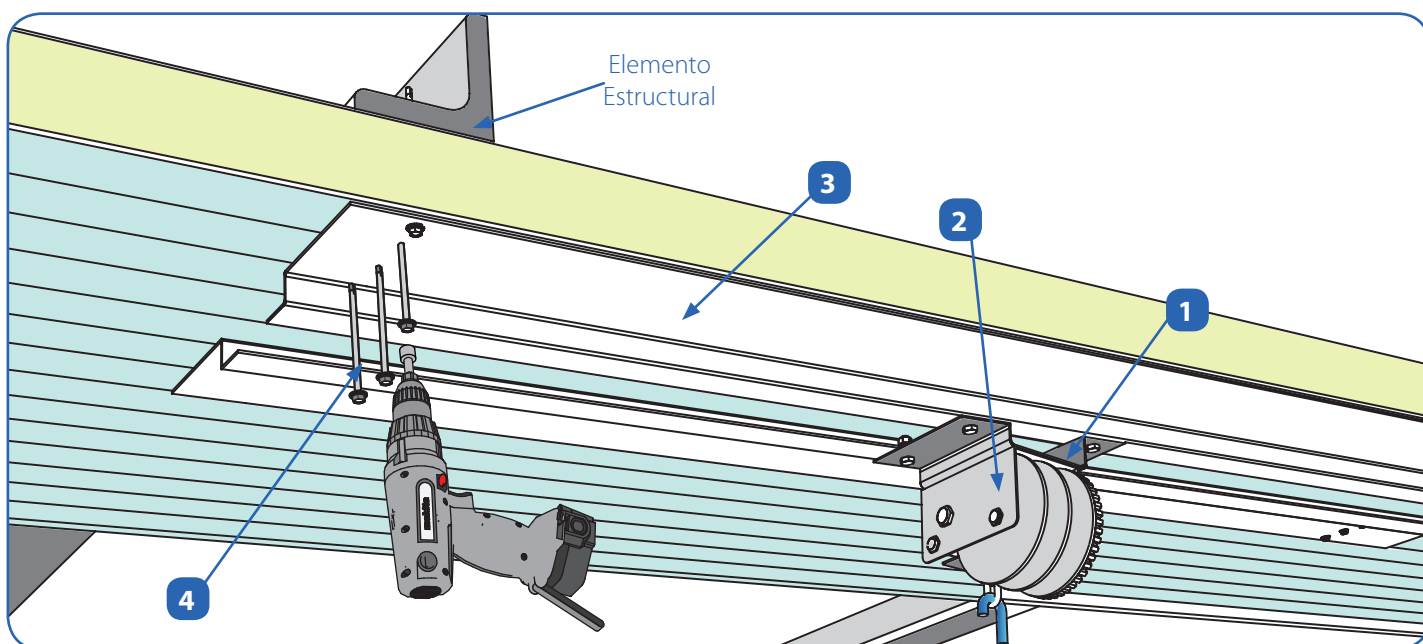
Zona de anclaje del Soporte torno en cubierta. Taladro colocación torno en cubierta, anclándolo a elementos estructurales.
